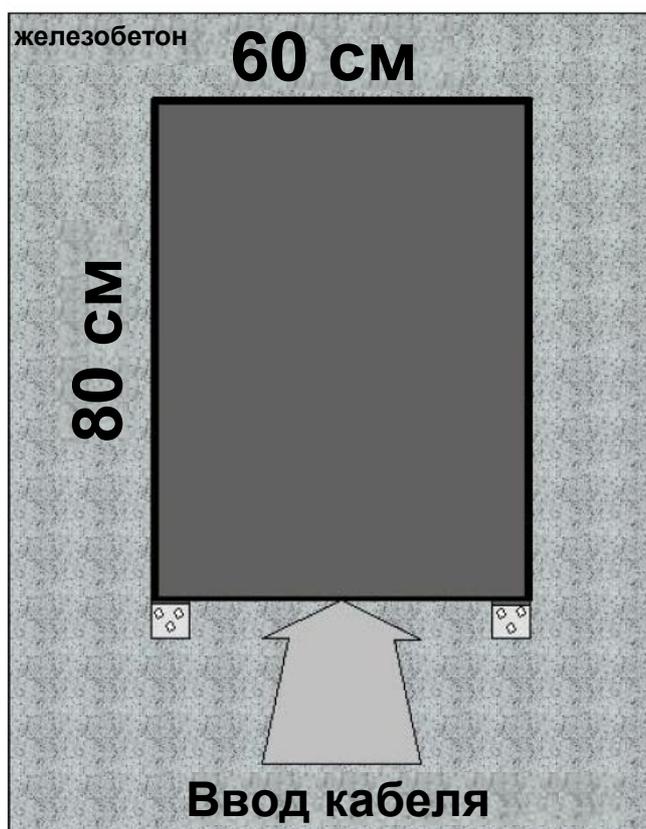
Установка на железобетонную стену с помощью опорных кронштейнов
